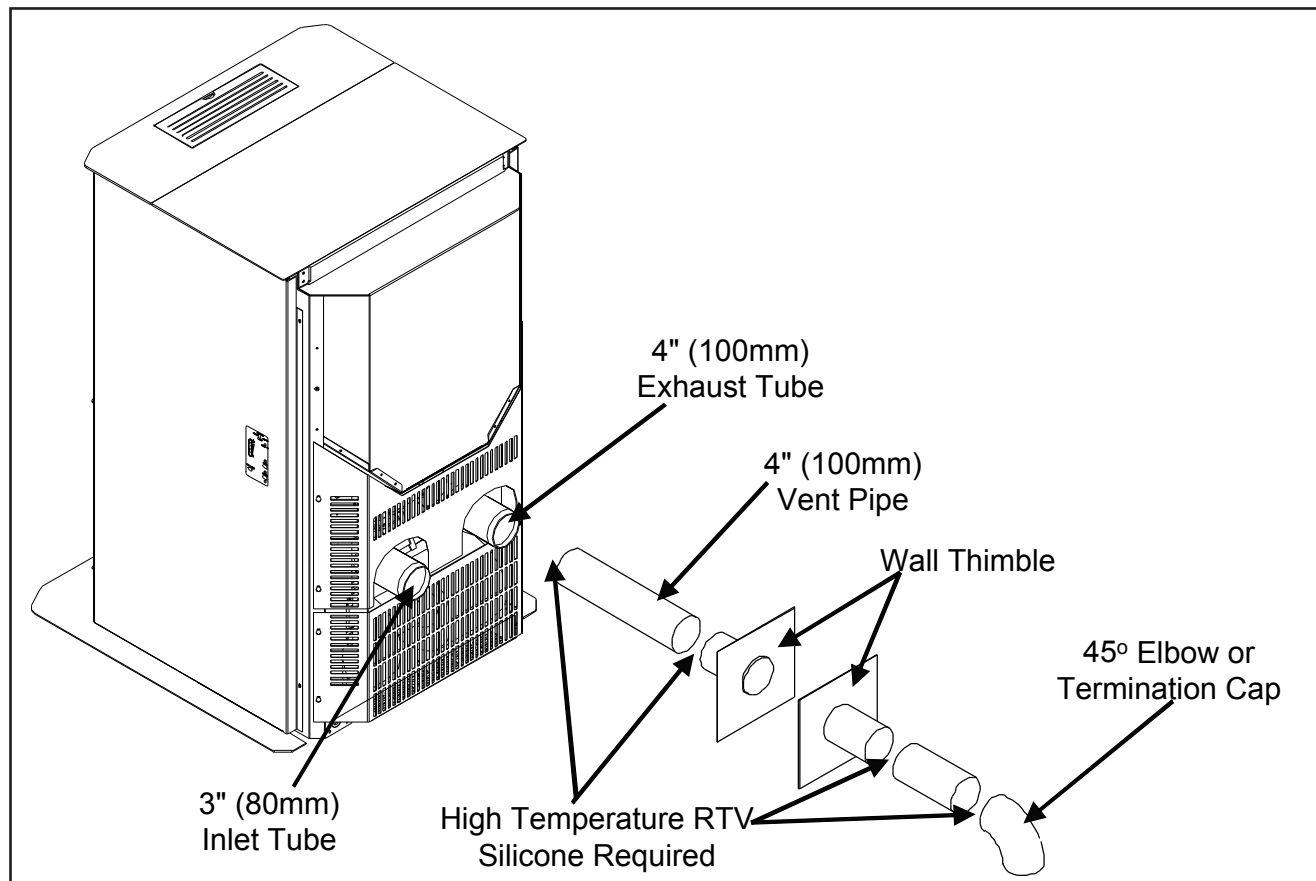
Tout Droit à Travers la Paroi de L'installation.
